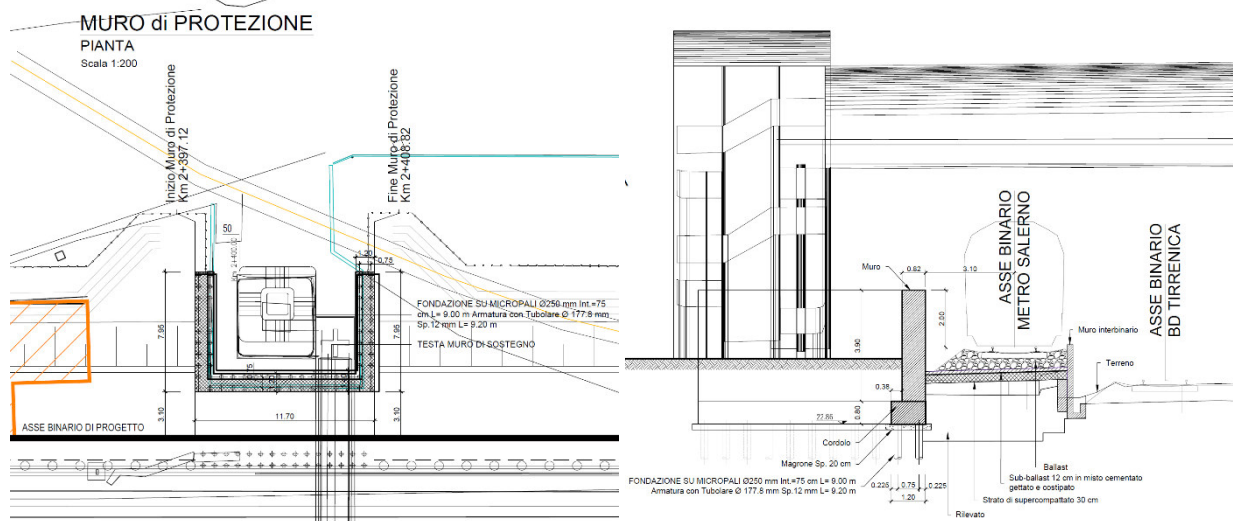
Opera di protezione della passerella pedonale alla pk 2+406 (pianta e sezione)
